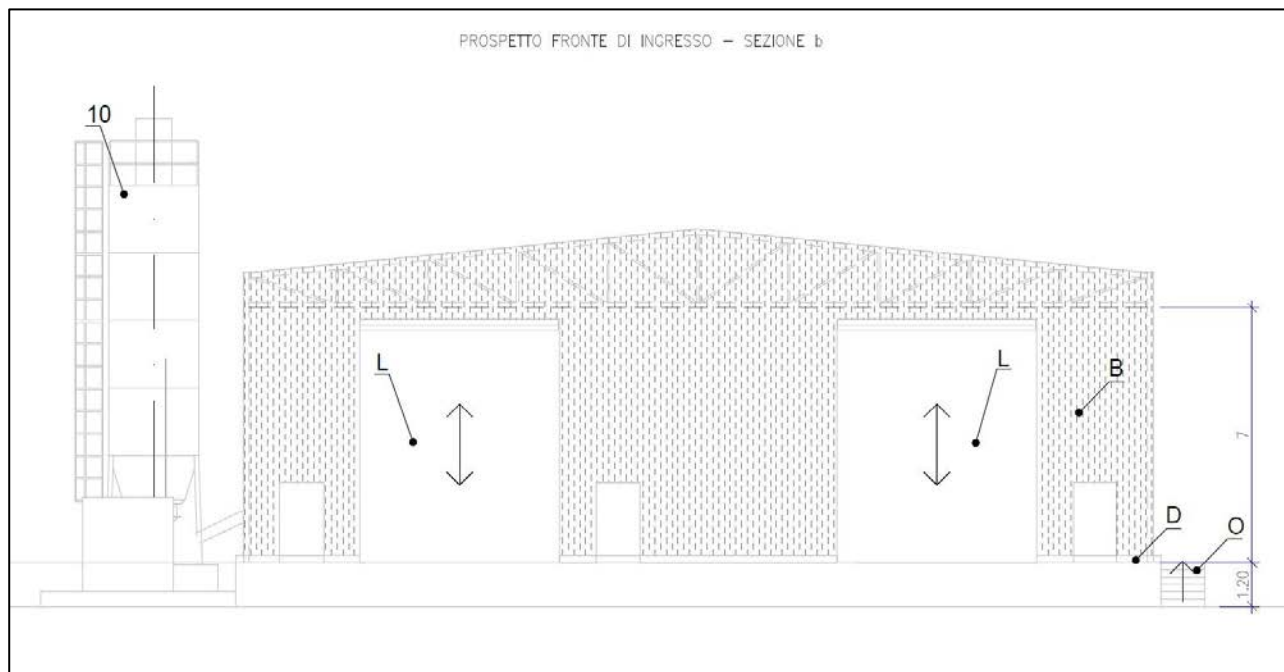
Prospetto Capannone Impianto inertizzazione
